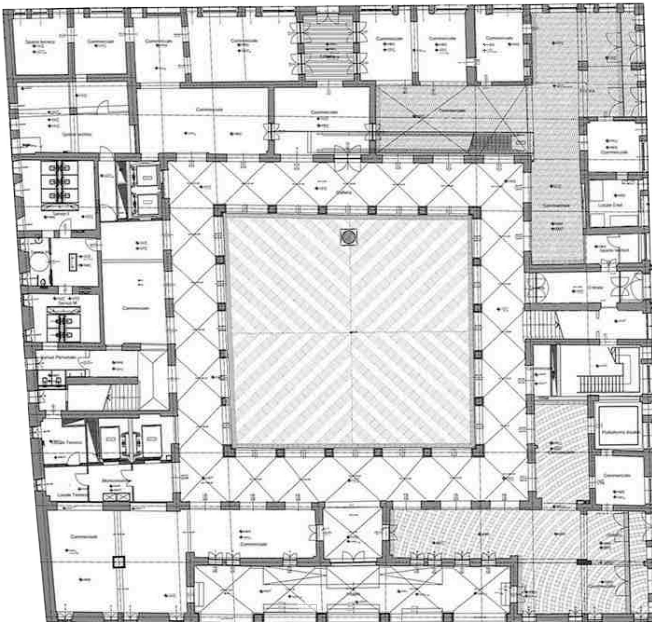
Erdgeschoss Grundriss, OMA.
